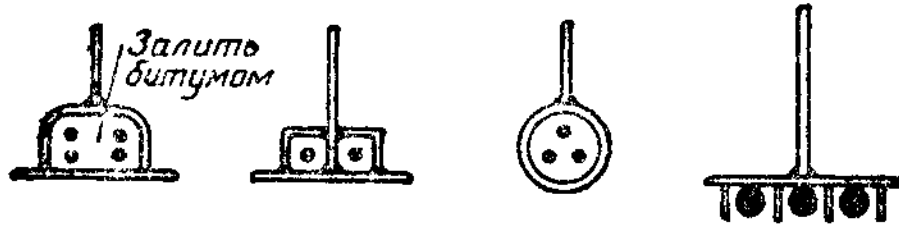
Типы поперечных сечений нижнего пояса предварительно напряженных балок
